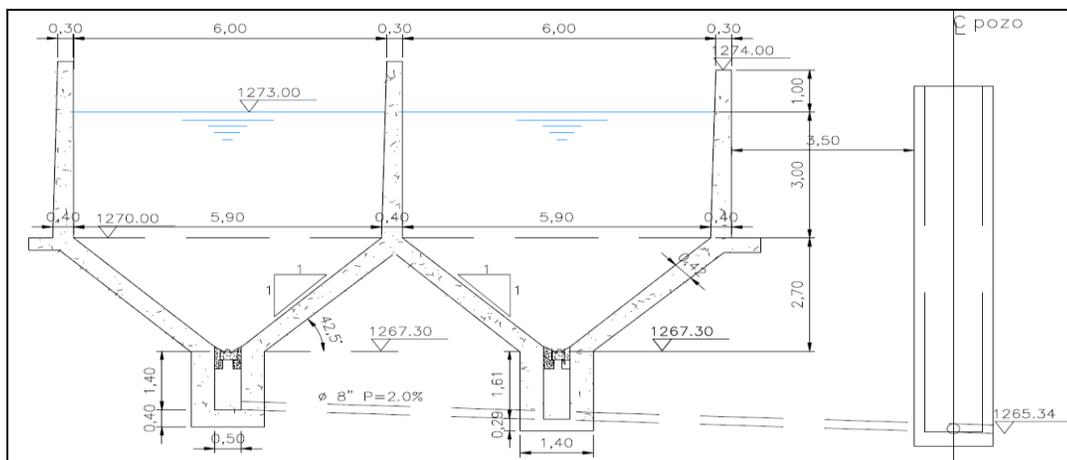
Corte del desarenador, canal de descarga y pozo de inspección
